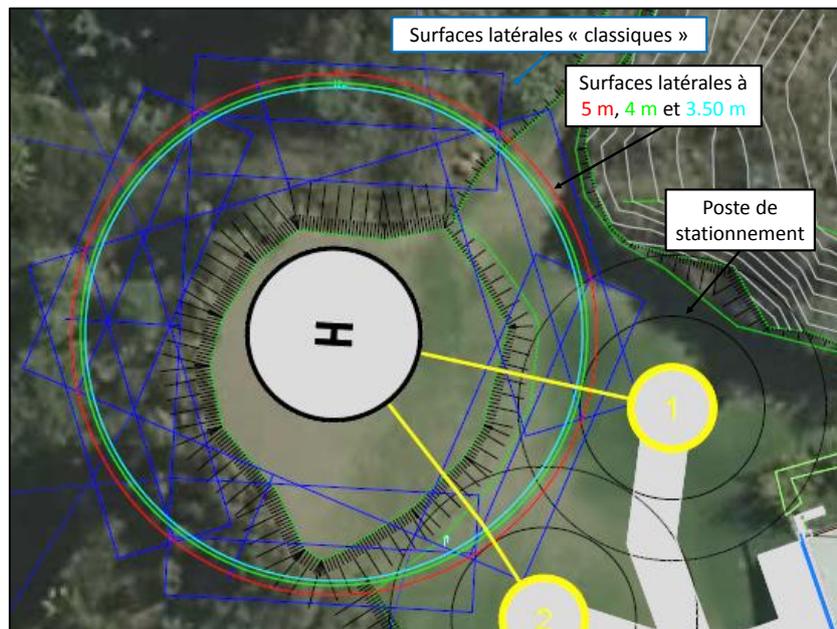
Définition des surfaces latérales associées au cône d'envol
